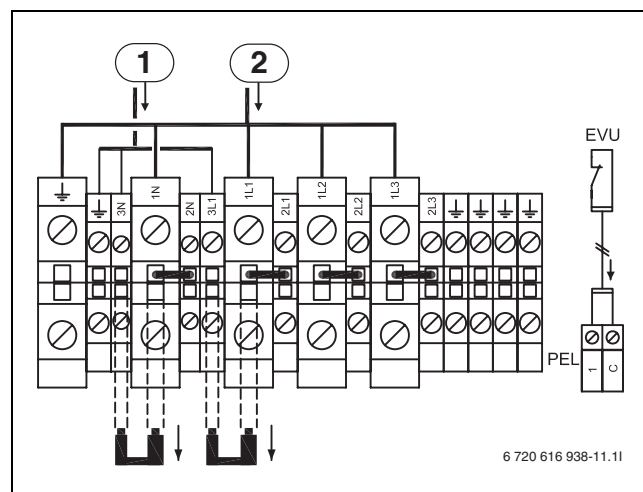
Anschlüsse Alternative A (T 430-1 - T 600-1)
